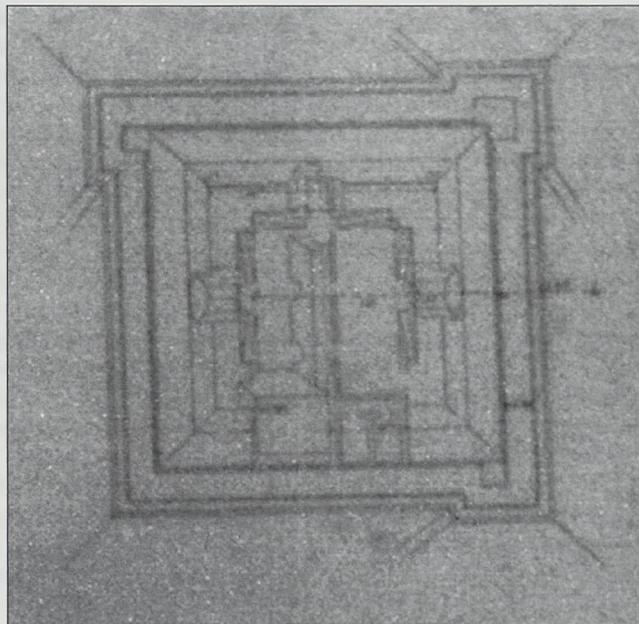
Detalle de la batería cuadrangular en el Rastrillar propuesta en el «Ante-proyecto de obras de fortificación para la referida plaza», de Manuel Vallespín, 1884. AGMM, 3ª, 3ª, leg. 103
